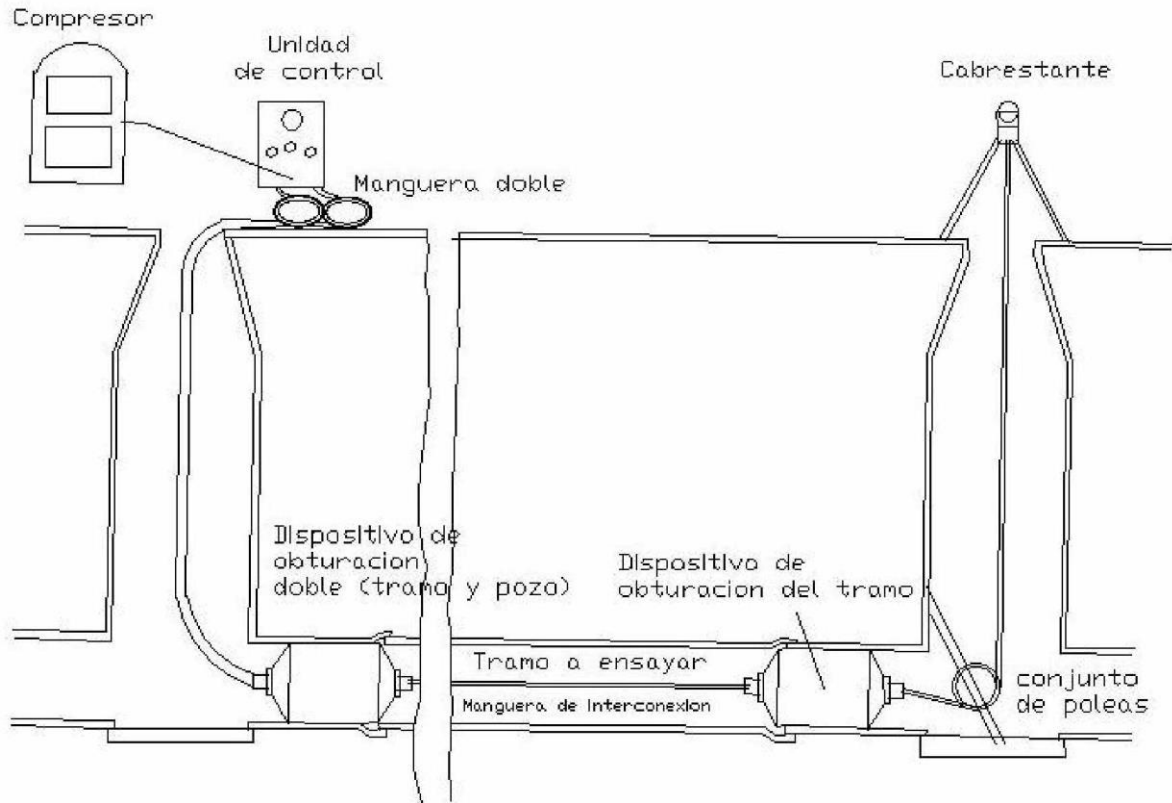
Prueba de baja presión en un tramo de alcantarilla entre dos pozos de registro.
